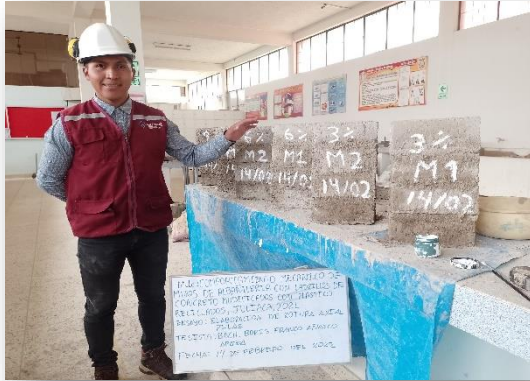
48 Elaboración de las pilas de LC con plástico PET reciclado
